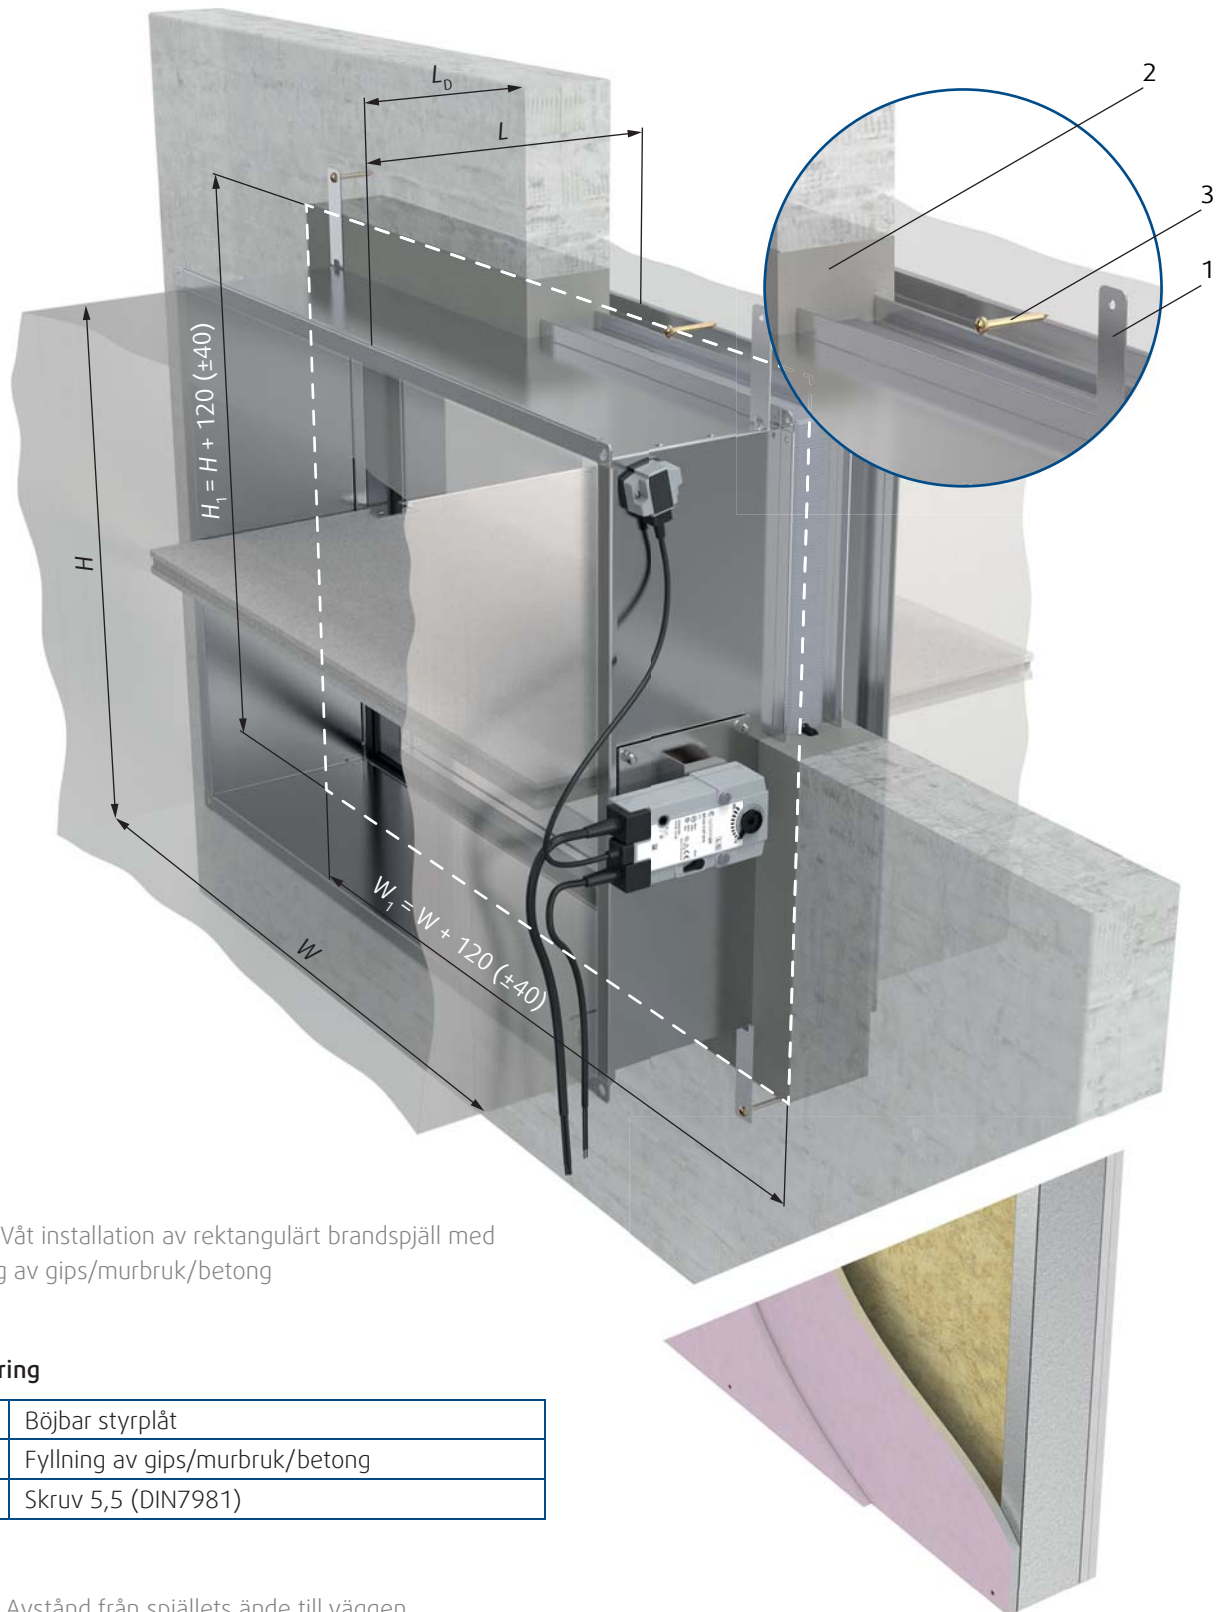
Våt installation av rektangulärt brandspjäll med fyllning av gips/murbruk/betong
